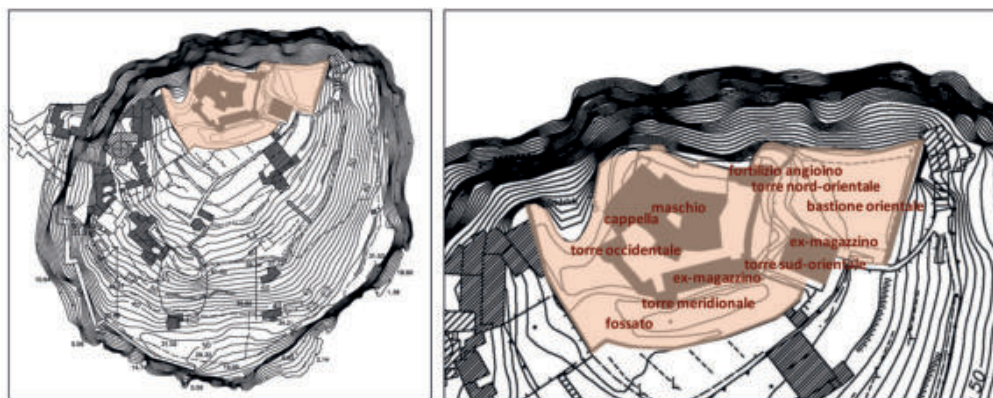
Planimetria attuale dell'isolotto e particolare del castello (elaborazione grafica di Francesca Capano)
